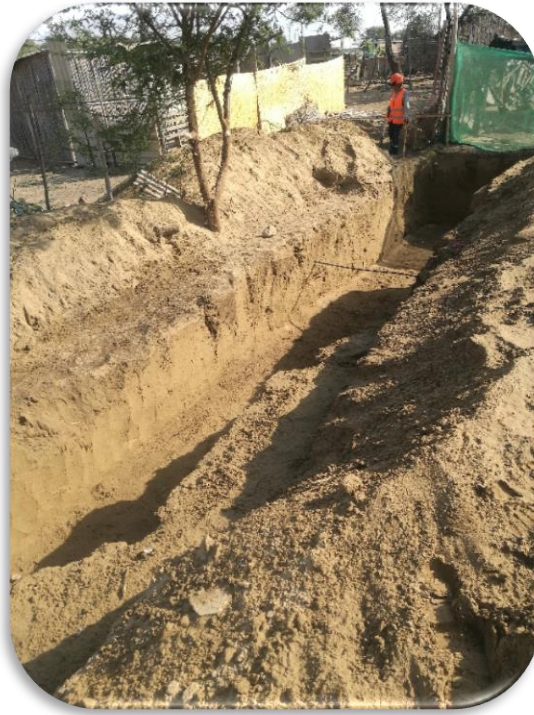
y 08: Excavación de zanja para Muro de Contención.
